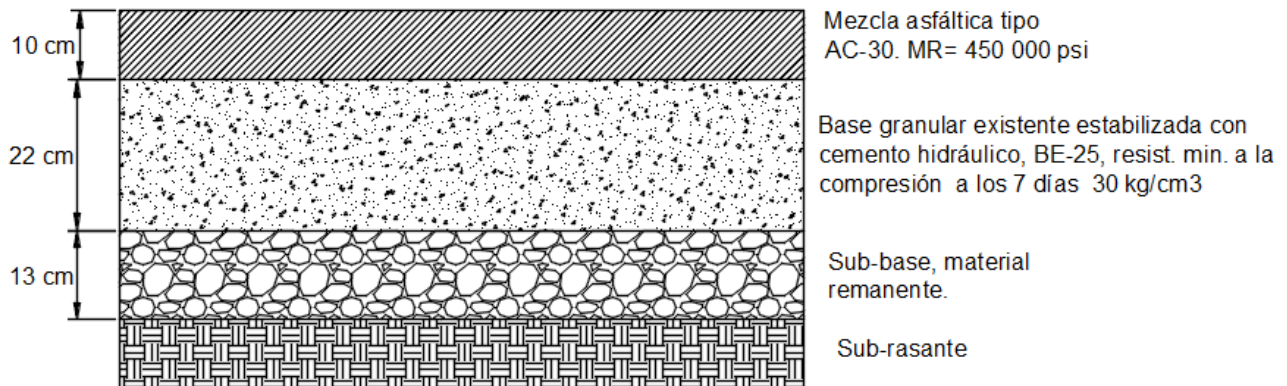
Perfil de la estructura de pavimento propuesta para el TH=29, P#1.
